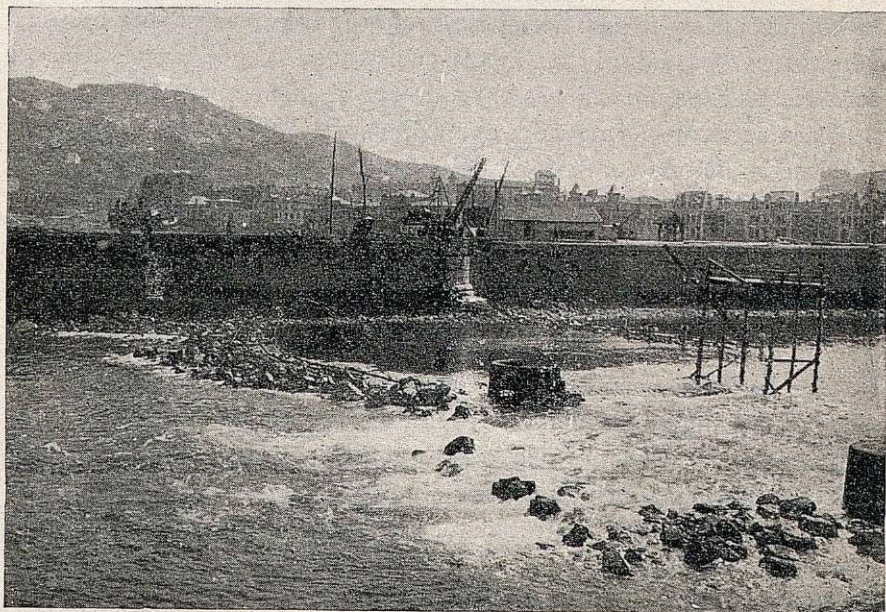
Construcción de la defensa de escollera en el puente del Kursaal (San Sebastián):
